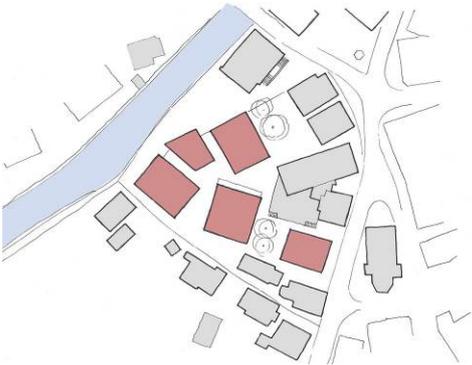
und 128: Testentwurf Variante 1 «Gesamtüberbauung» als Skizze und Plan [Quelle: CCTP]
